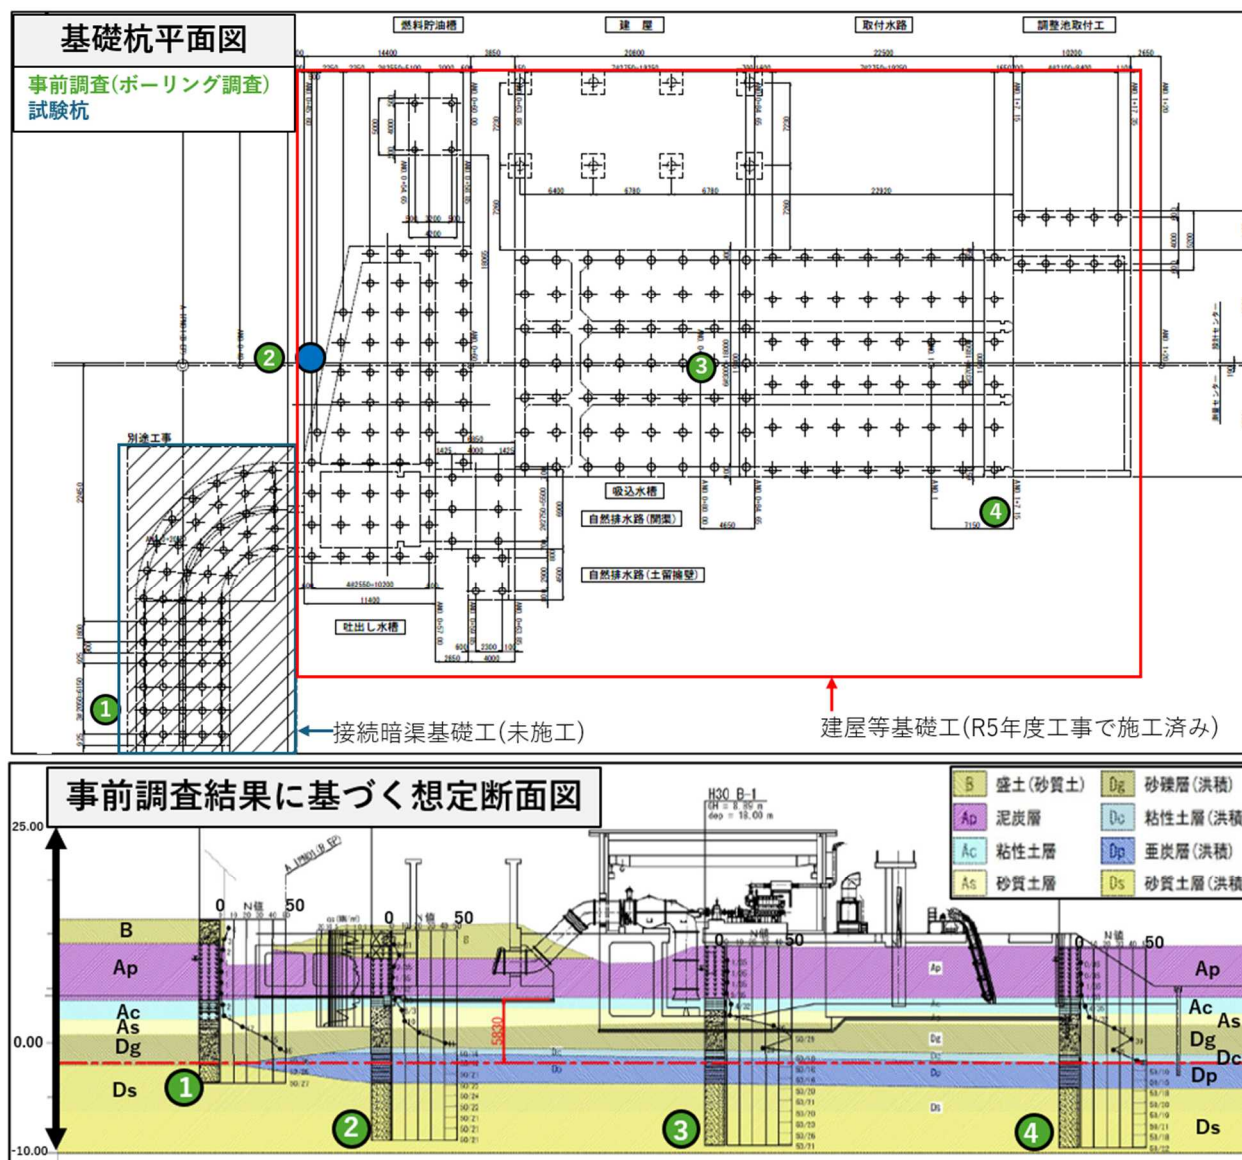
基礎杭平面図と事前調査結果に基づく想定断面図
